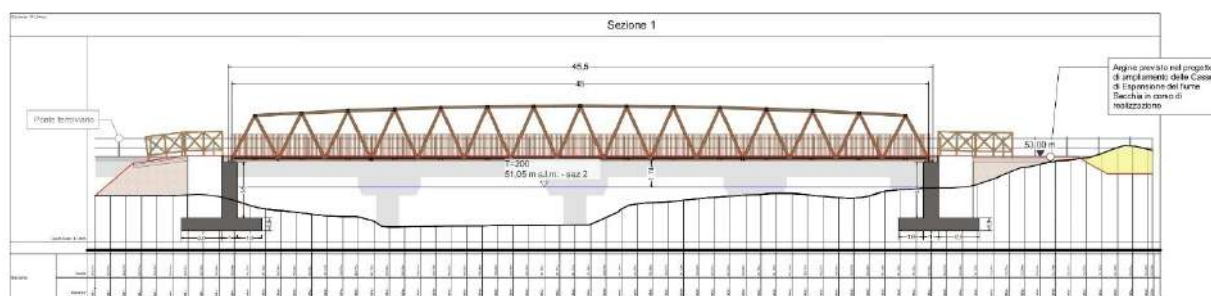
Sezione dell'opera in progetto (Fhare Associati).
